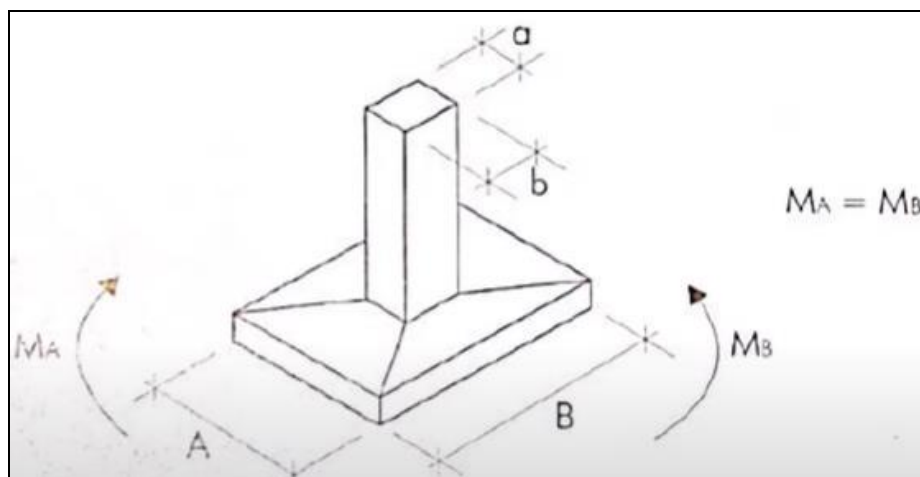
Dimensionamento de sapata isolada retangular. (Fonte: Rebello, 2008)
